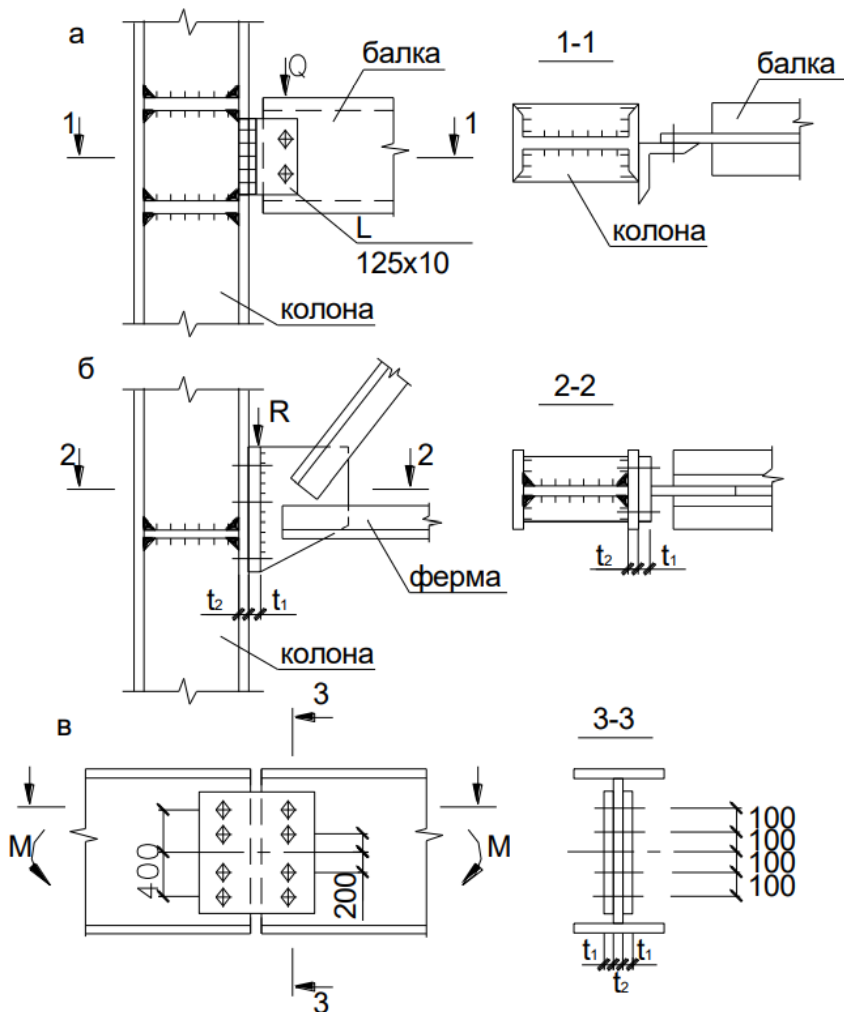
Болтові з'єднання сталевих конструкцій.
